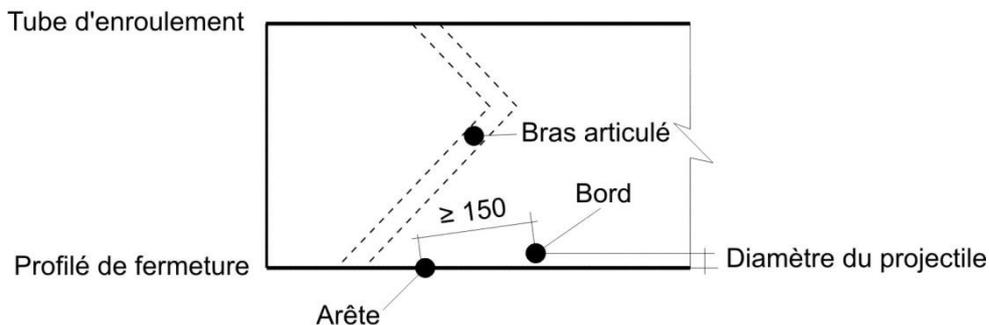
Points d'impact sur un store à bras articulés, vus en plan (dimensions en millimètres).
